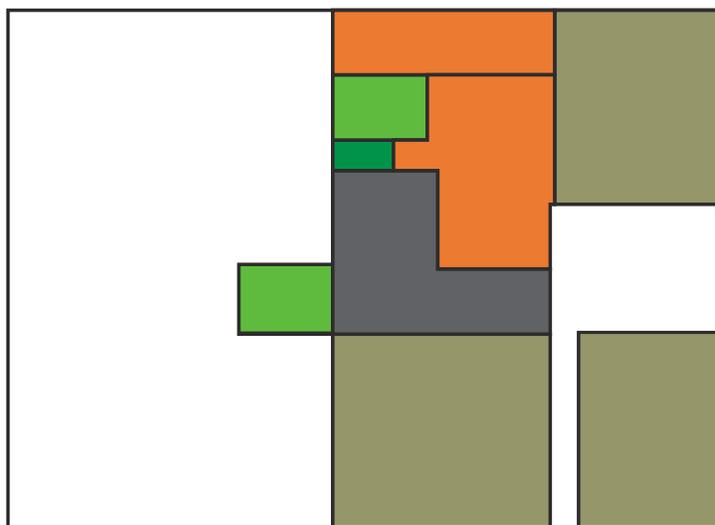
Zoneamento de Usos – 3° Pavimento
